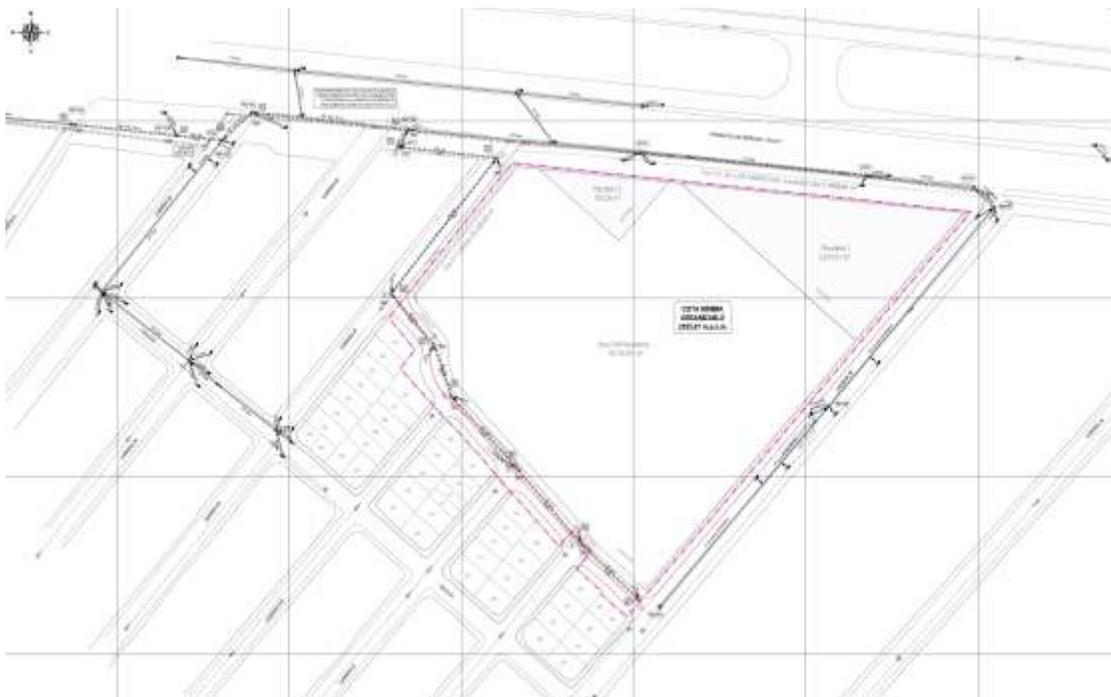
Red de Alcantarillado Pluvial, Plan Parcial Cartón Colombia
